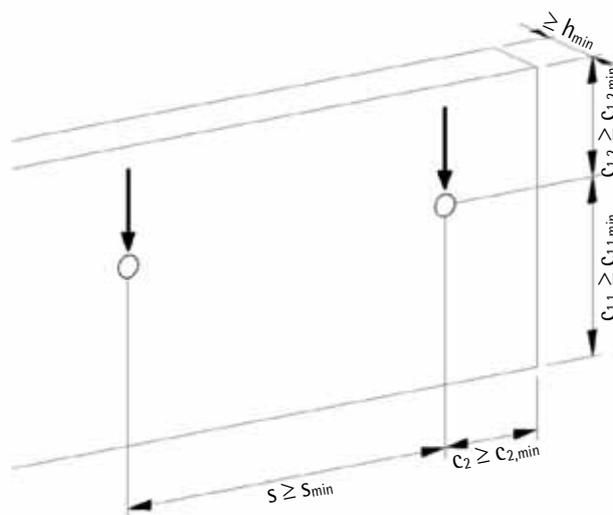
Einbausituation Wandfläche - Querbeanspruchung
